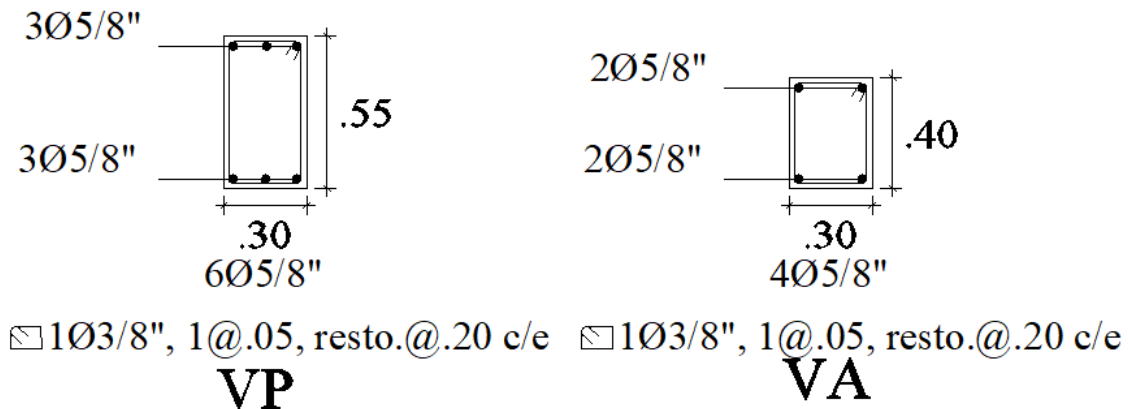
Armado del acero de refuerzo en las vigas. Elaborado por el investigador.
